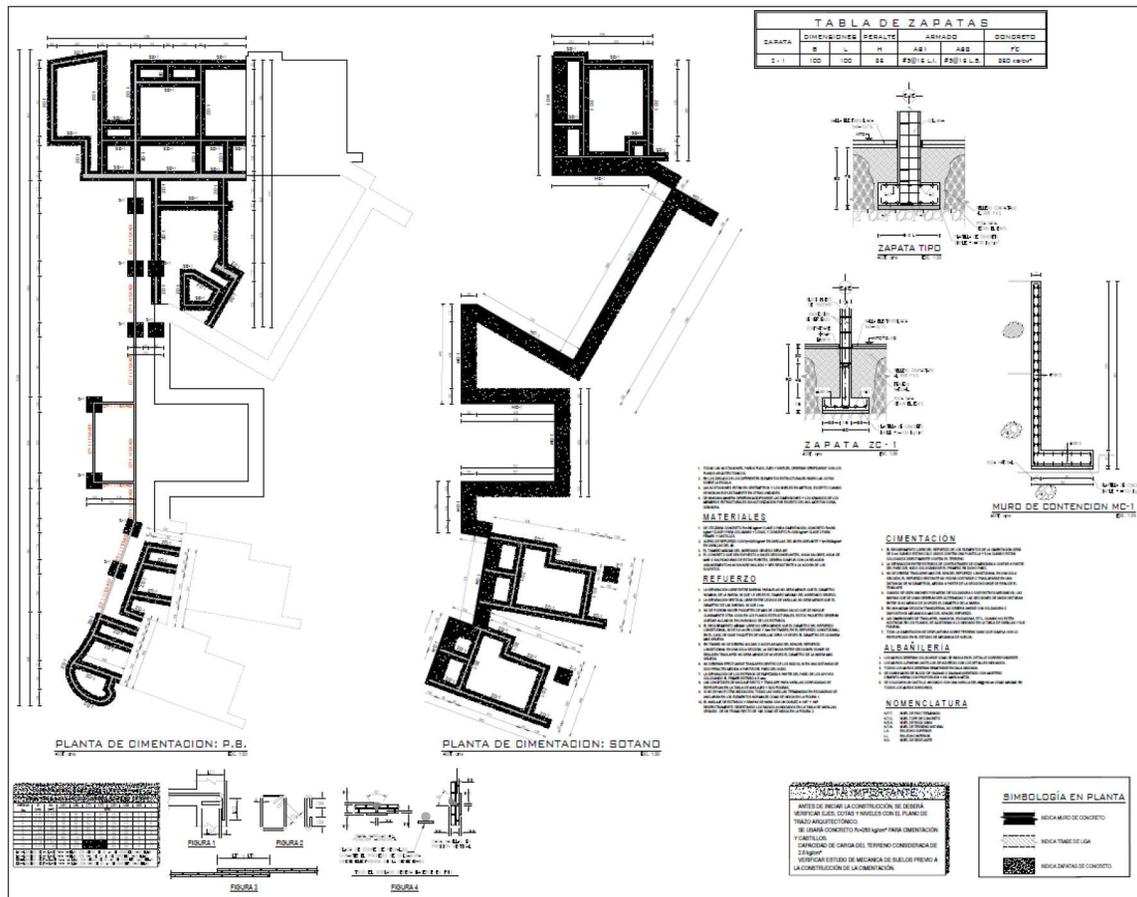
Plano de cimentación del proyecto CASA CAMINO AL VIENTO.
